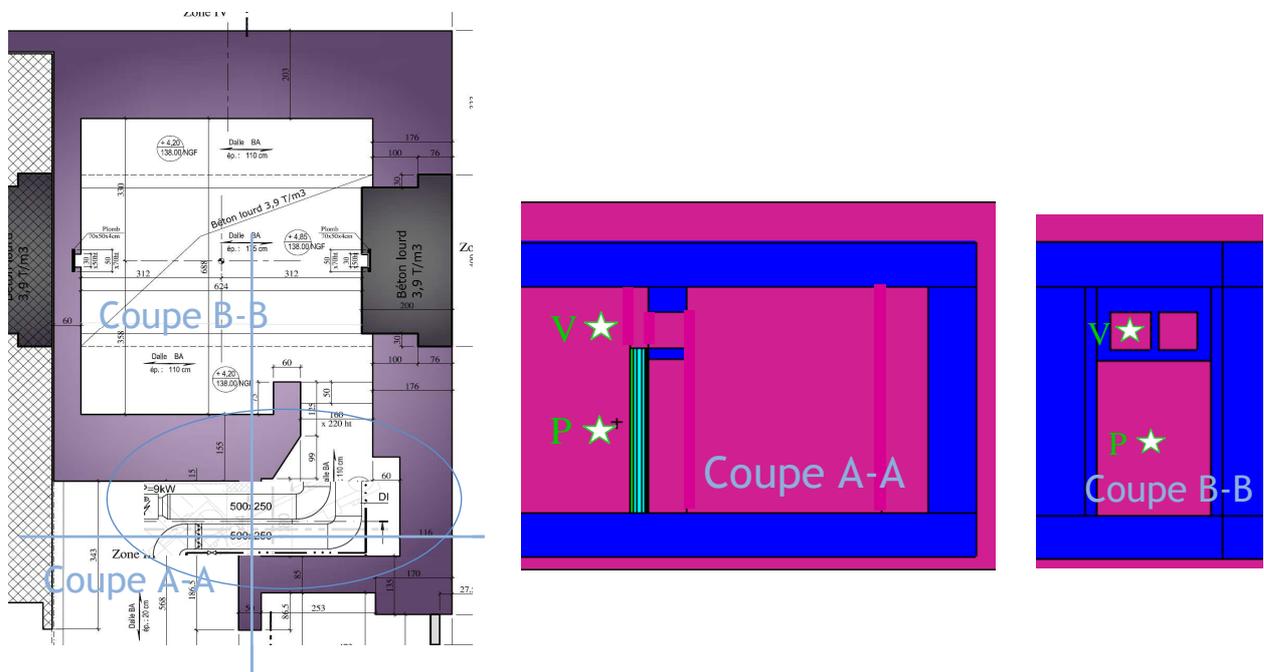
Plan d'un projet de construction d'un bunker de radiothérapie, avec une chicane courte et des percements droits du linteau au-dessus de la porte d'entrée pour le passage de deux conduits de ventilation : vue de haut (gauche), coupes verticales A-A (milieu) et B-B (droite)
